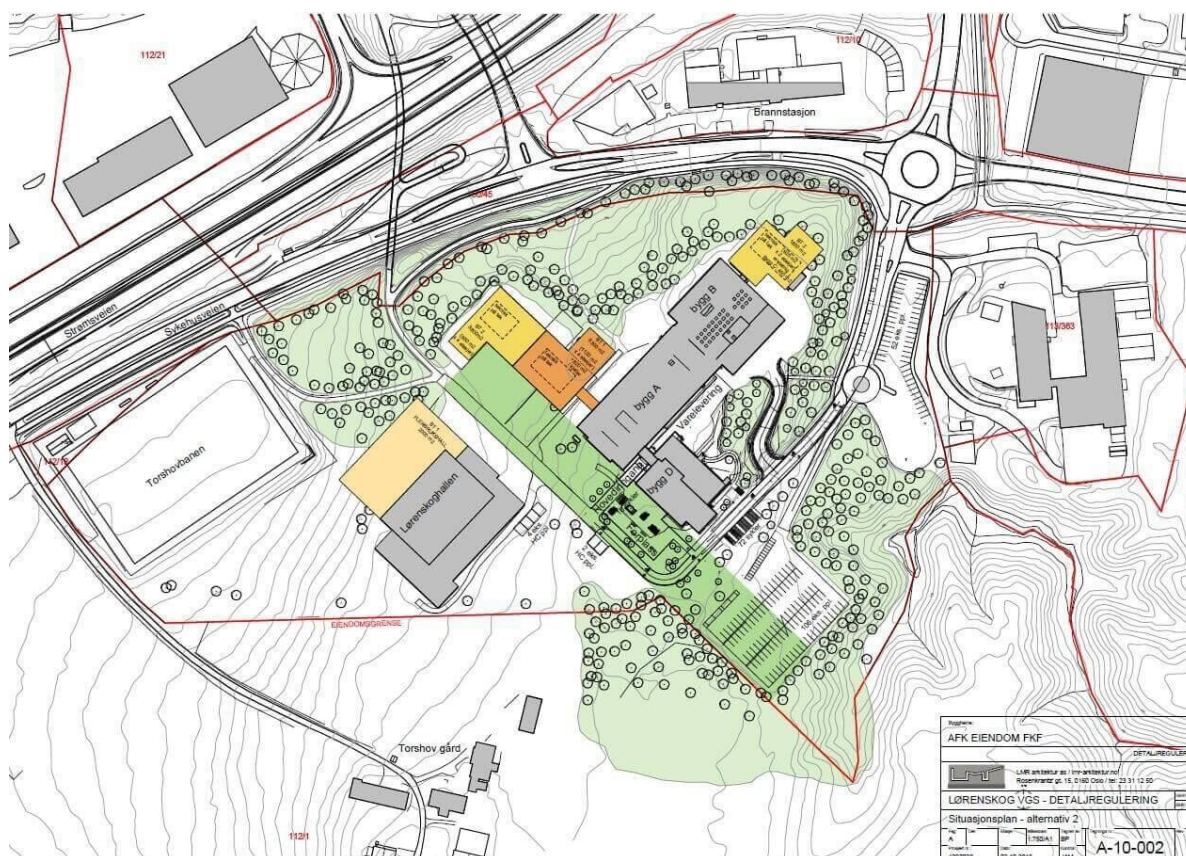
Illustrasjonsplan fase 2, full utbygging, volumer.
